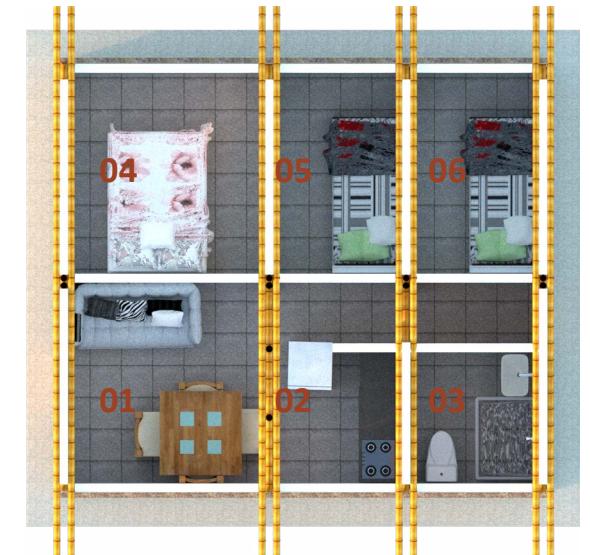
[Figura] Planta única de Casas libertador Bolívar. Fuente: Autor
